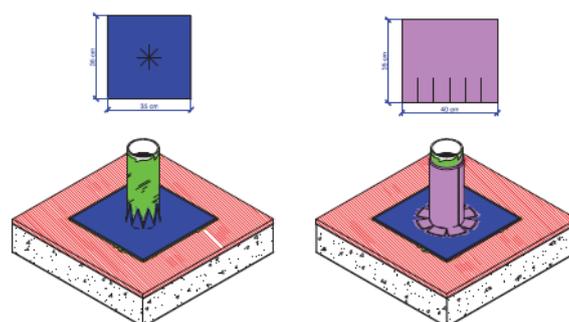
Detalhe de arremate de impermeabilização em tubos passantes. Fonte: VEDACIT (2016)
